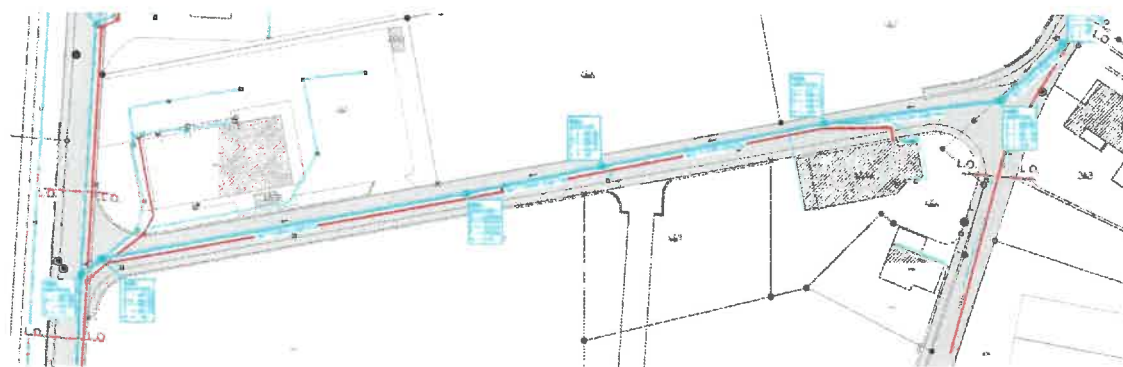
Estratto piano 21.44A-204 Planimetria di progetto
